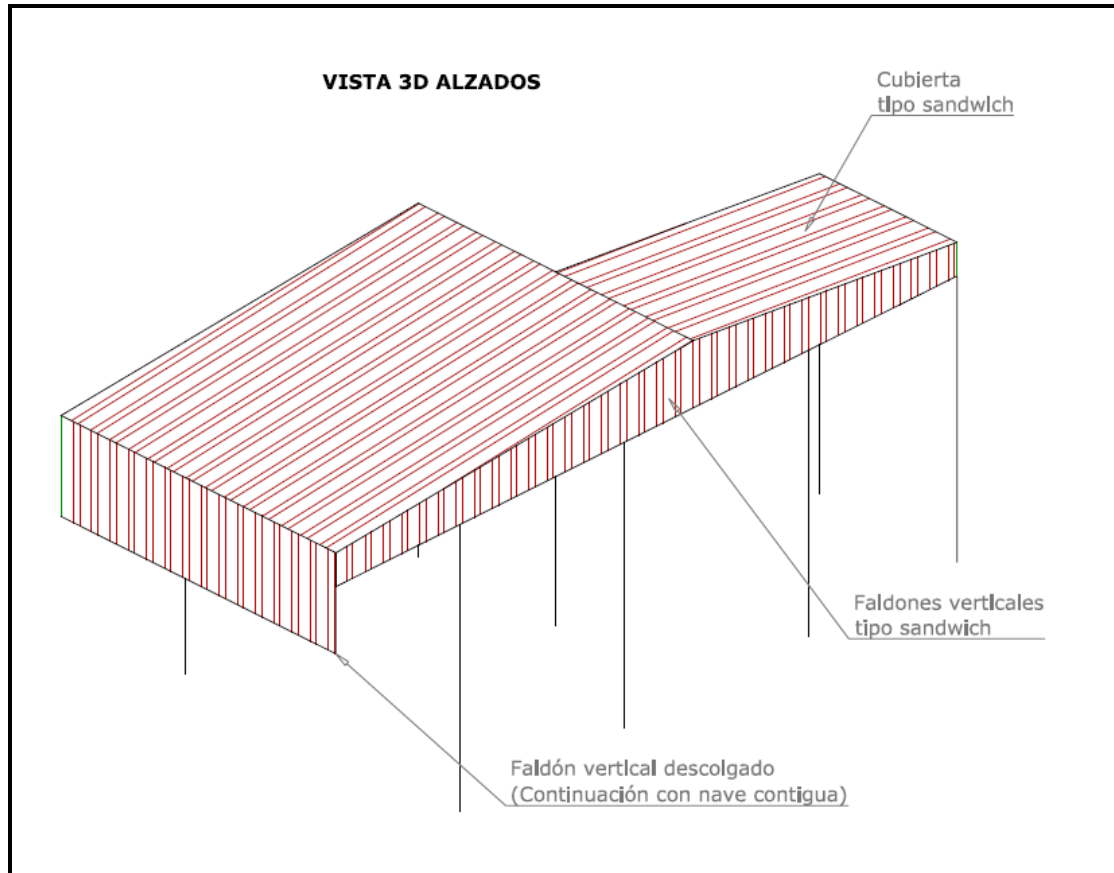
Vista 3D cubierta para silos leche de cabra.
